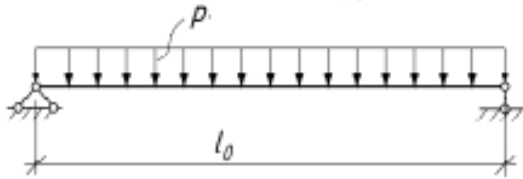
Расчётная схема продольного ребра плиты ТТ
